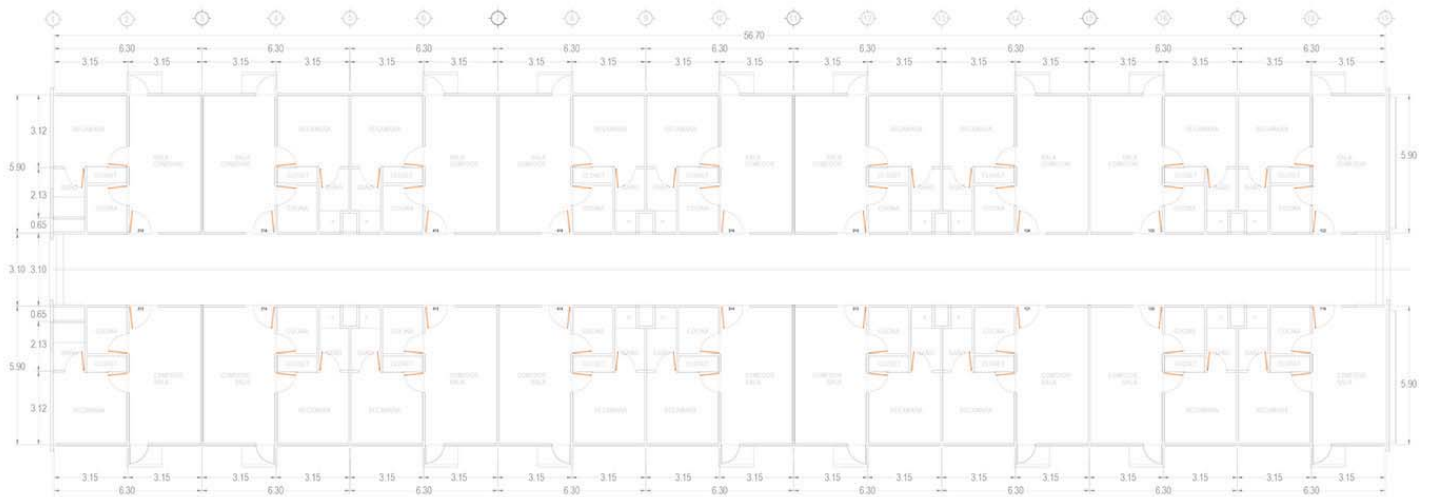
Planta edificio 3B .obras.cdmx.gob.mx
